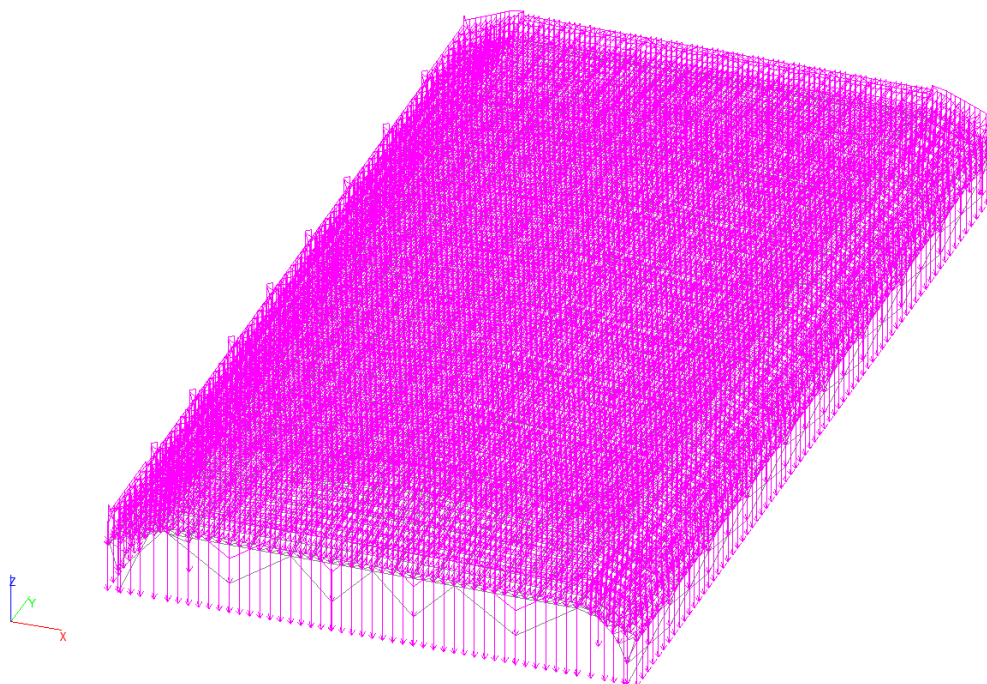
Нагрузка от собственного веса в ПК SCAD для варианта каркаса без консолей
